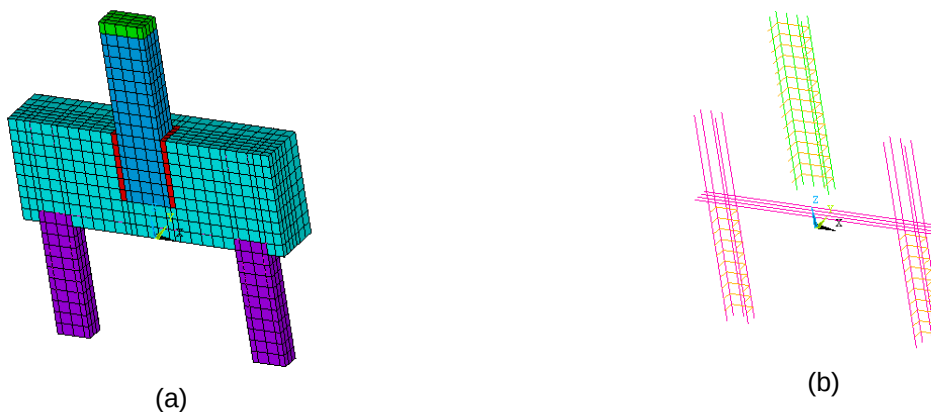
Rede de Elementos Finitos – (a) concreto; (b) armadura.
